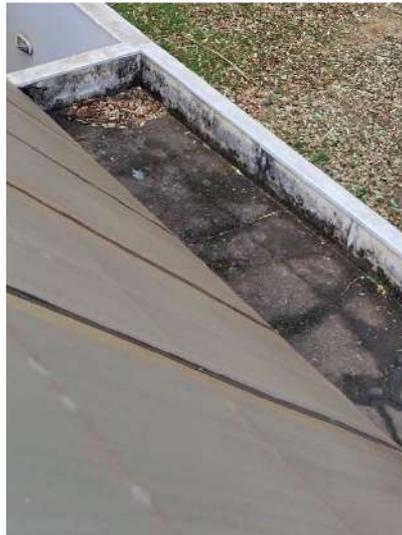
Deterioração da impermeabilização da laje sobre hall principal
